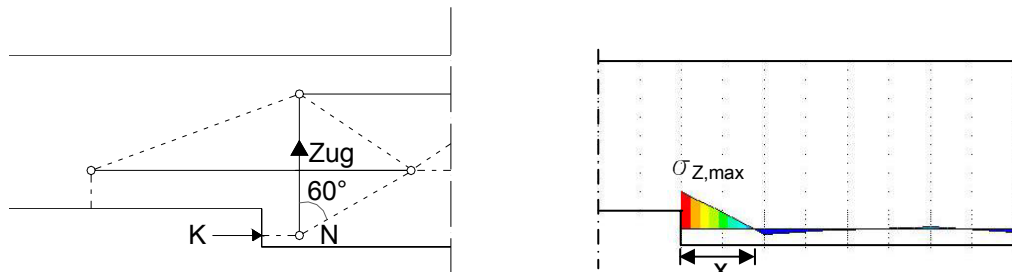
Betonversagen bei Scherversuchen mit Magerbeton
